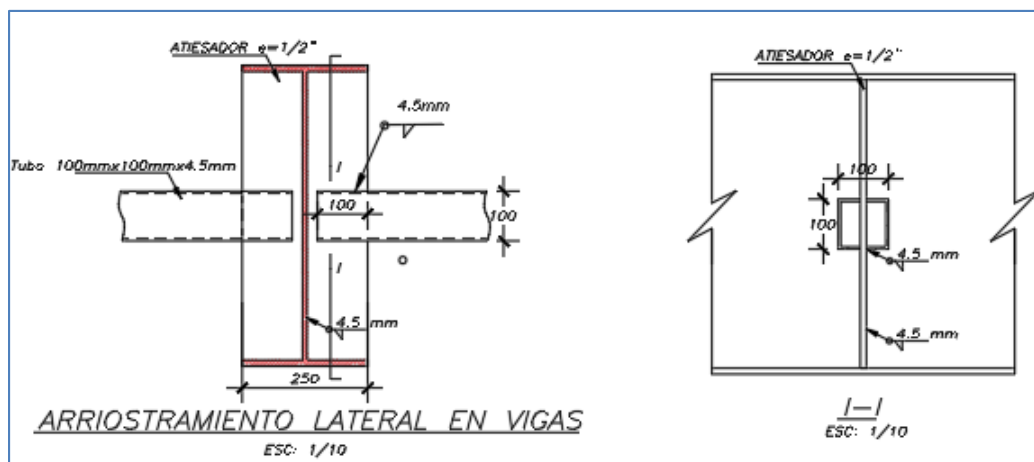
DETALLE DE ARROSTRAMIENTO LATERAL EN VIGAS DE PÓRTICOS
